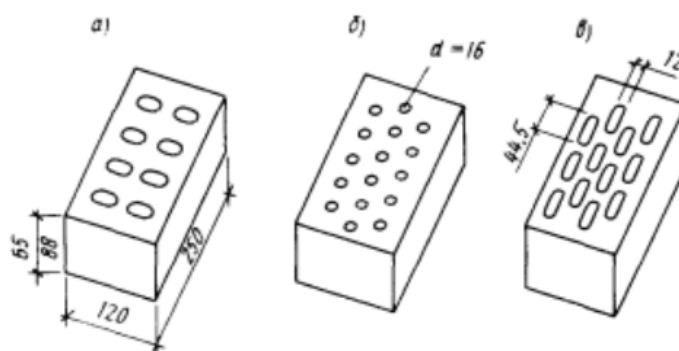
Виды кирпича: а - обыкновенный керамический кирпич полусухого прессования с несквозными пустотами; б - керамический кирпич пластического прессования с круглыми пустотами; в - то же, со щелевидными
